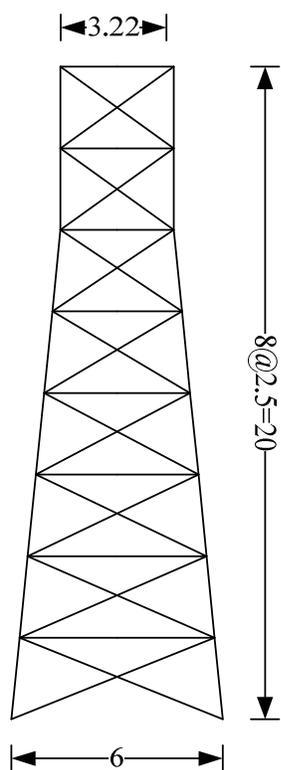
獨立鐵塔各向立面示意圖 單位 (m)
